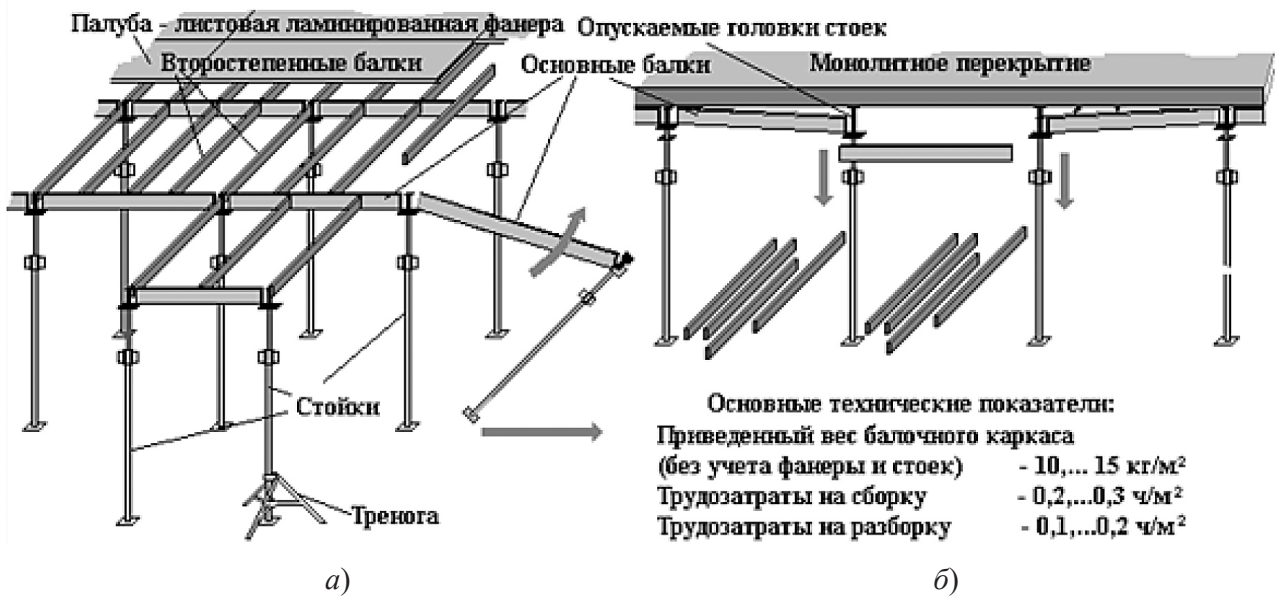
Балочный каркас опалубки перекрытий TITAN HV:
